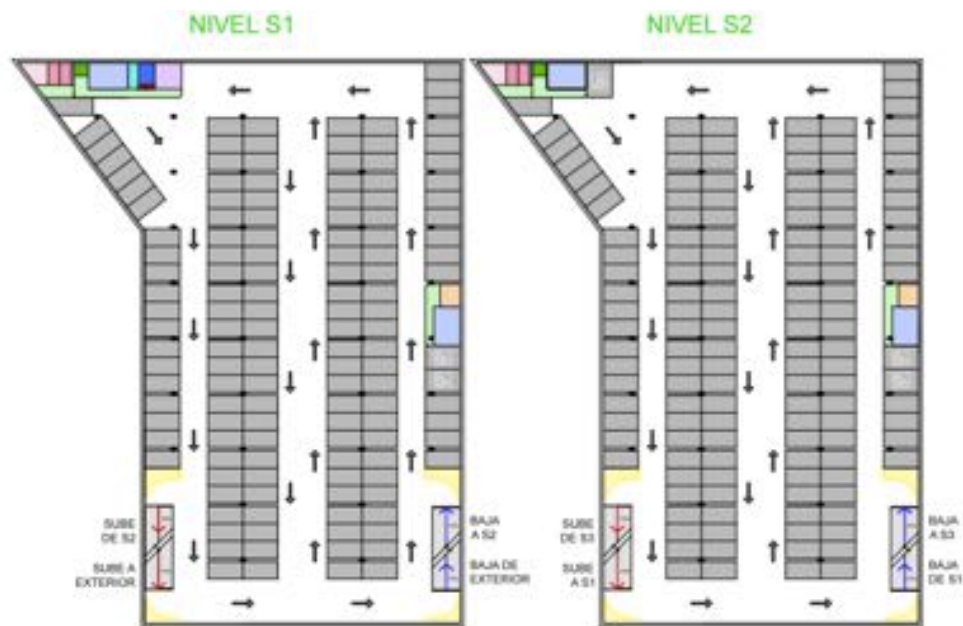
Alternativa 3 - Ubicación 2 y 2 Plantas
